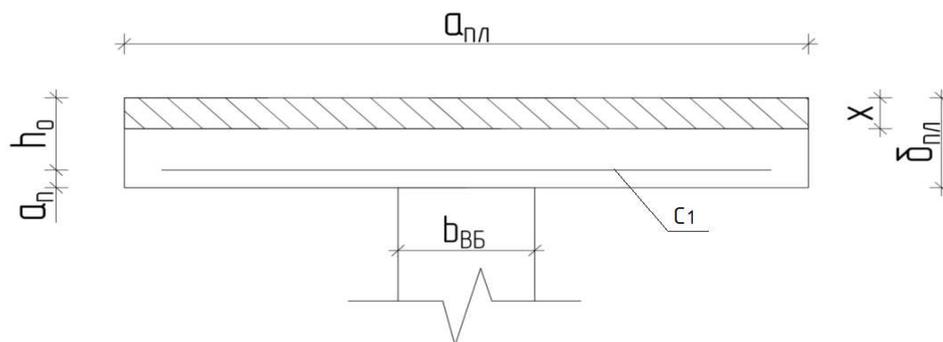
Геометрические параметры монолитной плиты Перекрытия
